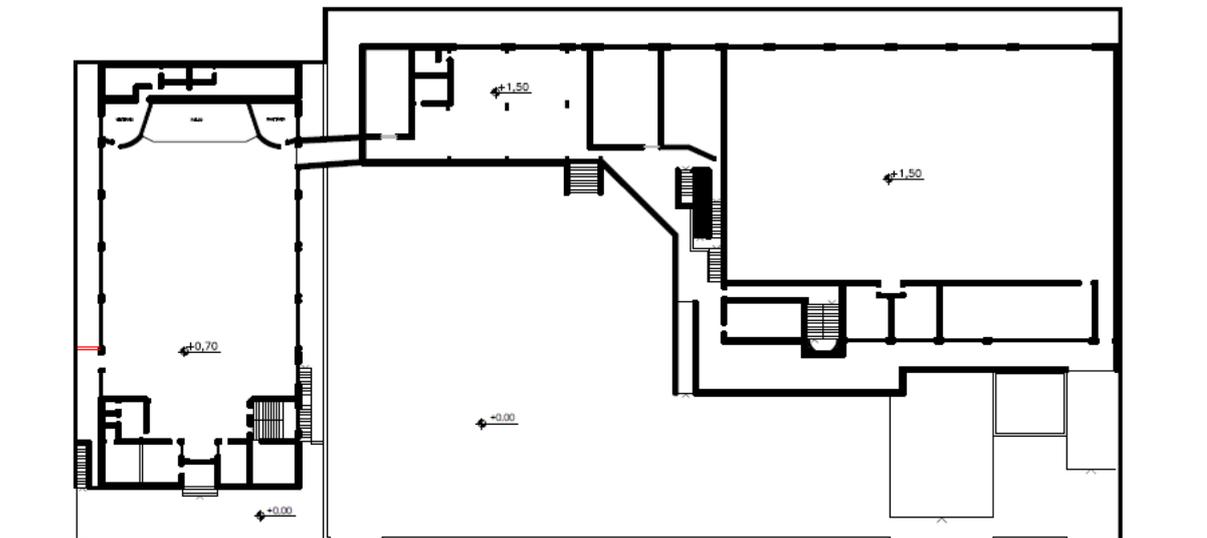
Planta Baixa Antiga - TÉRREO. Fonte: produzido pela Autora.
